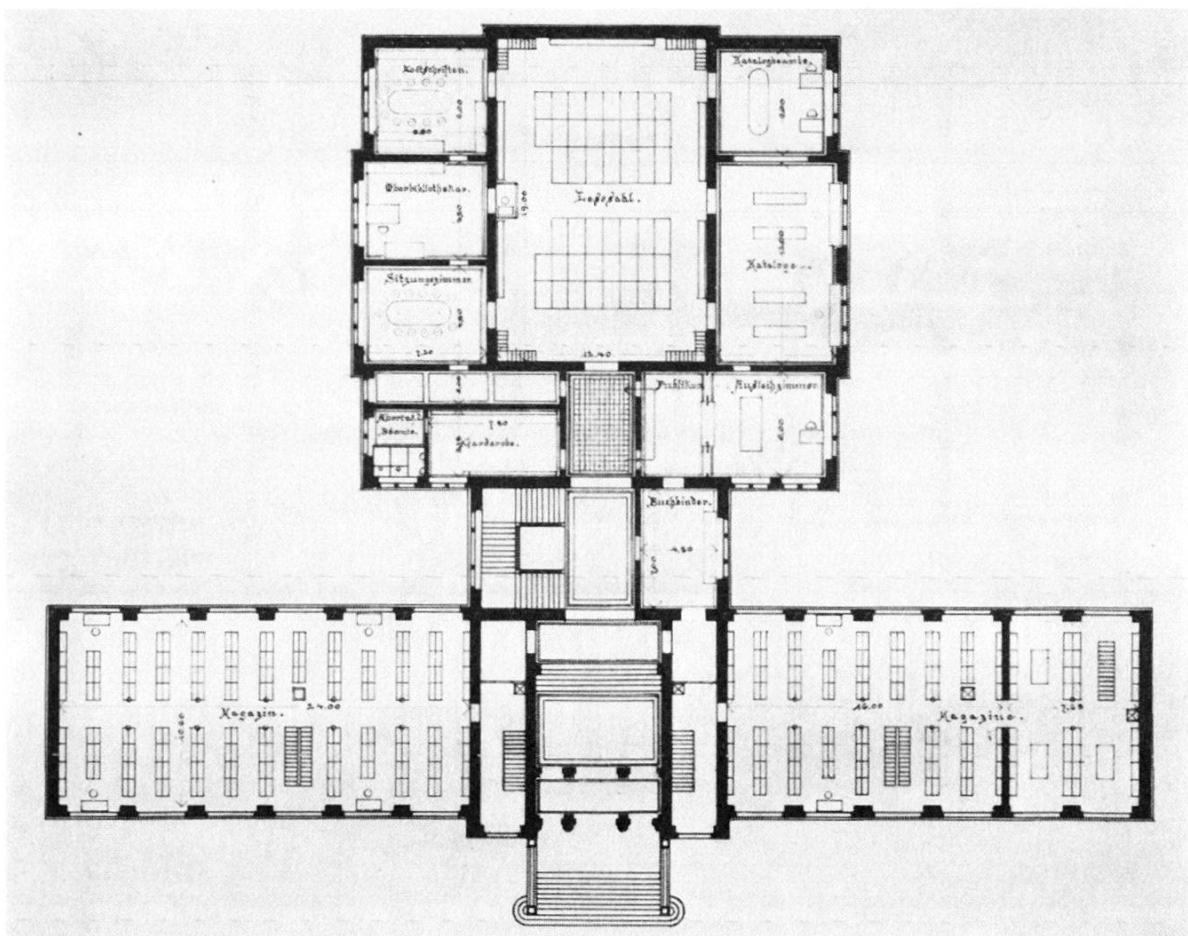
Bibliotheksprojekt von Moser, Grundriss des Erdgeschosses.
